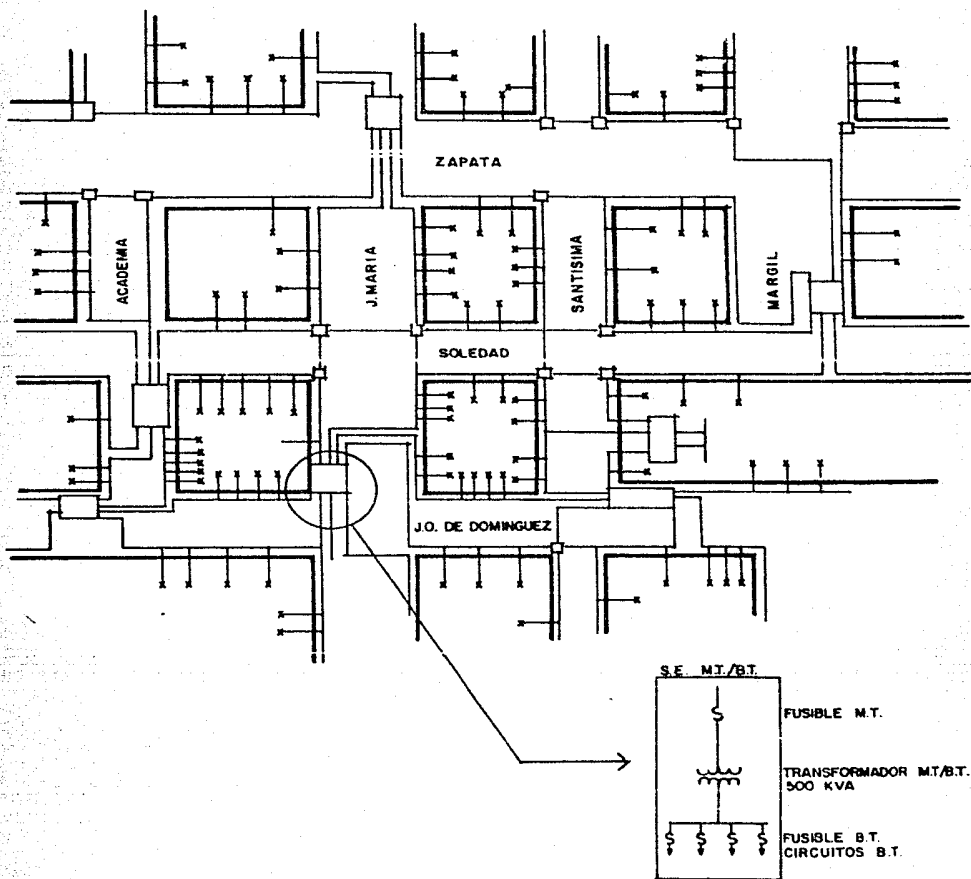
Estructura de baja tensión con seccionamiento
